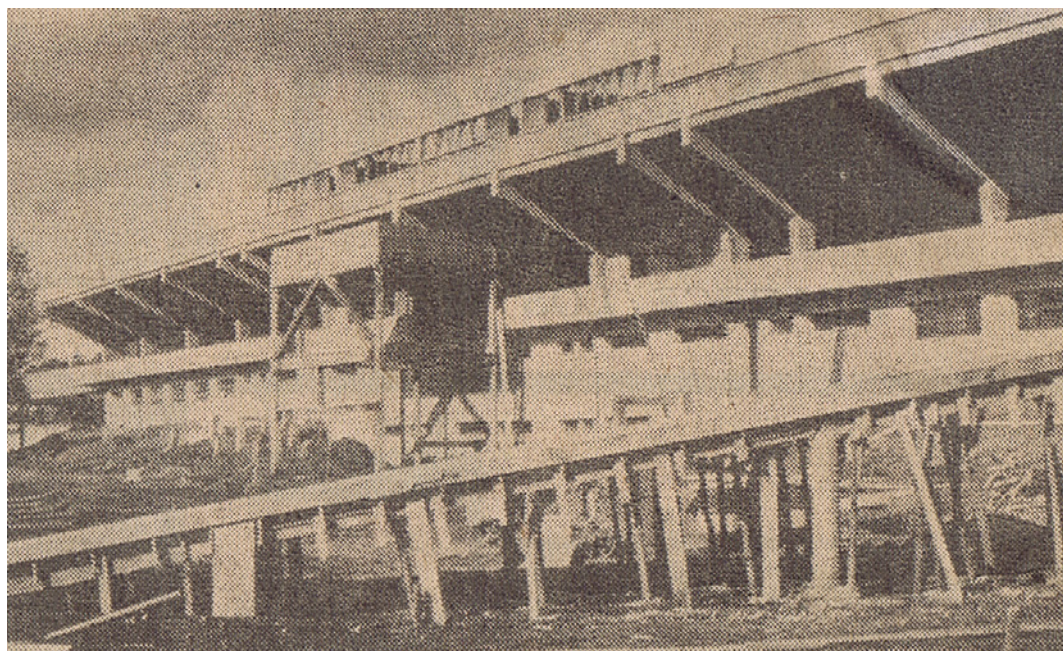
Tribuna Oficial en proceso de construcción. Fuente: Diario El País, 1966
